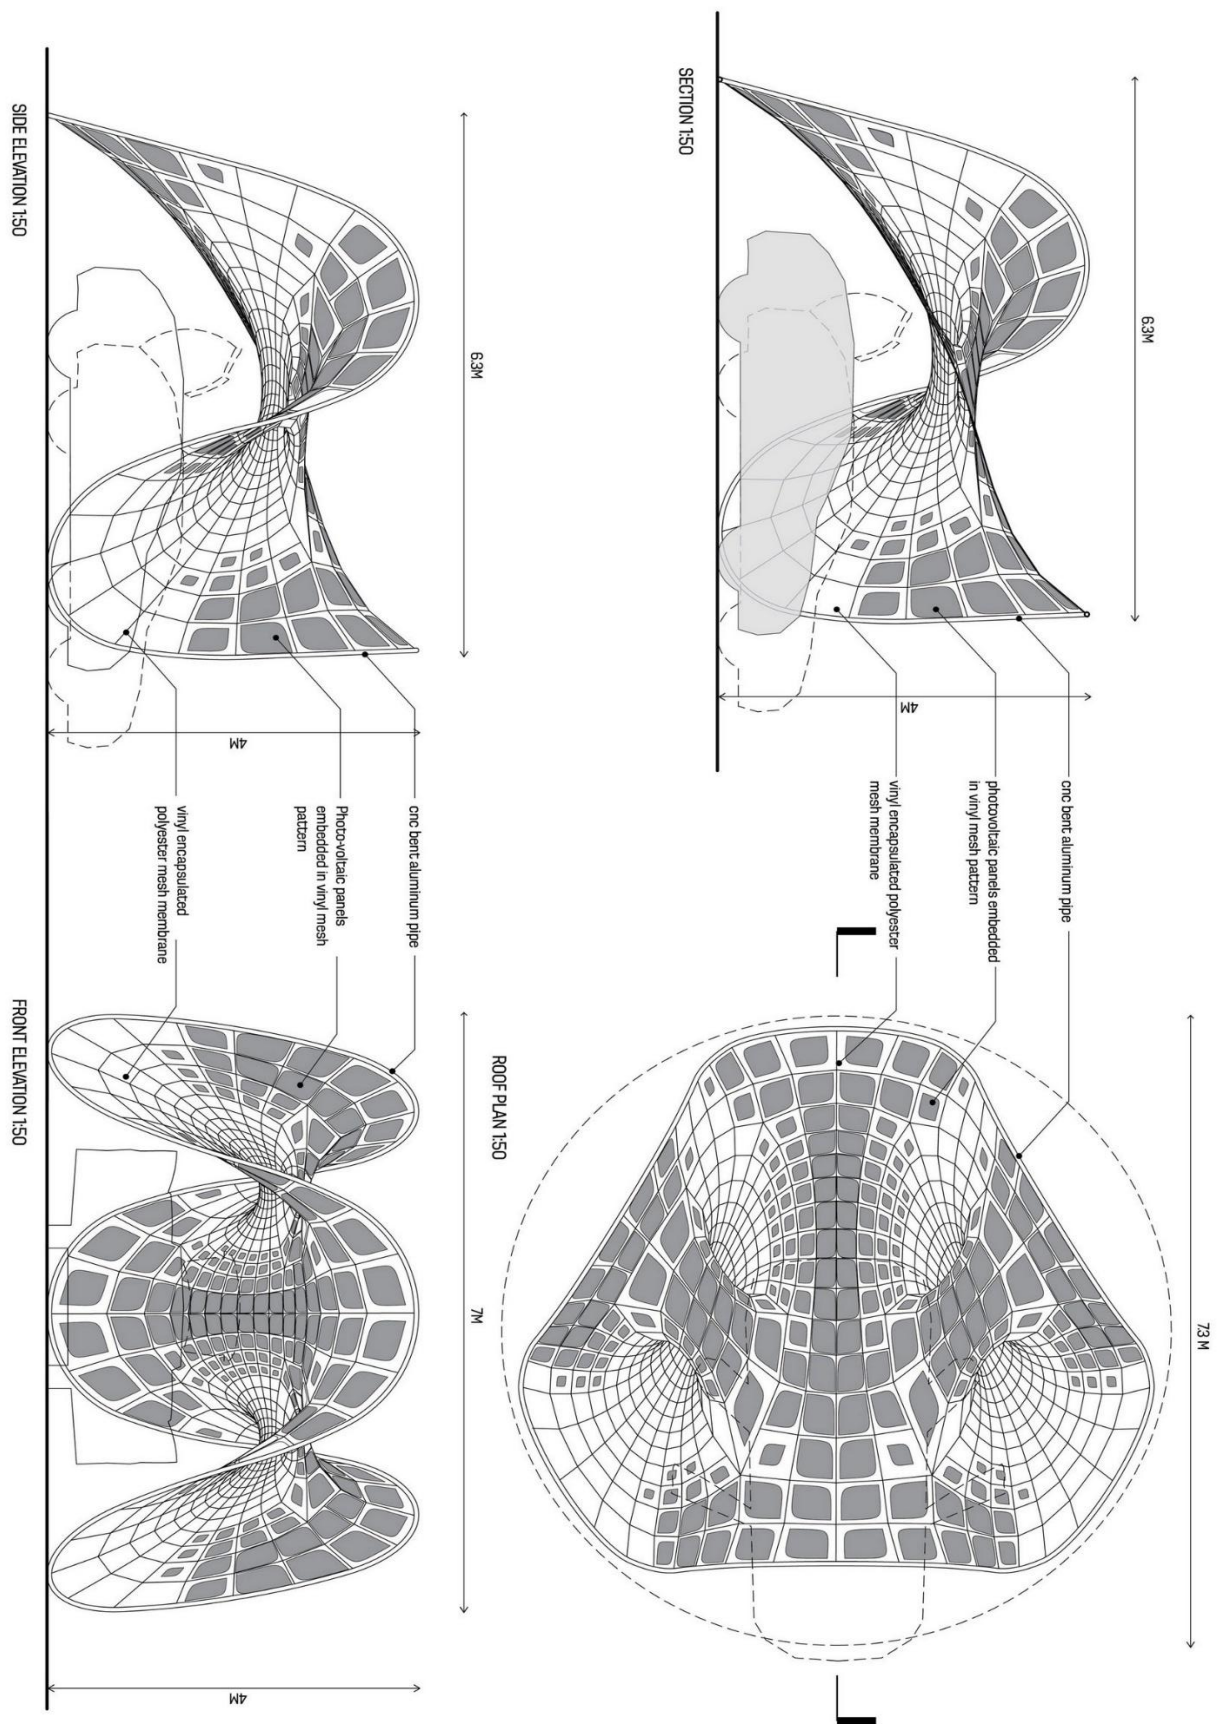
Coupe, plan et élévations de la structure Pure Tension.
